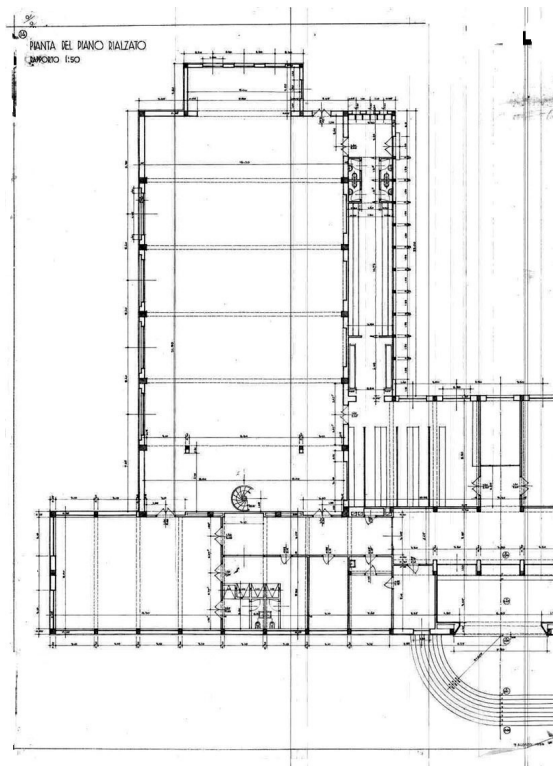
pianta del piano rialzato, zona della palestra, 9 agosto 1933.
